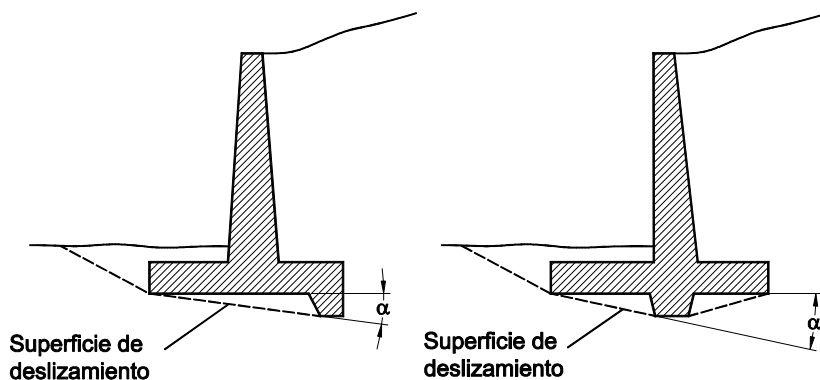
Posibles superficies de deslizamiento en muro con zarpa
